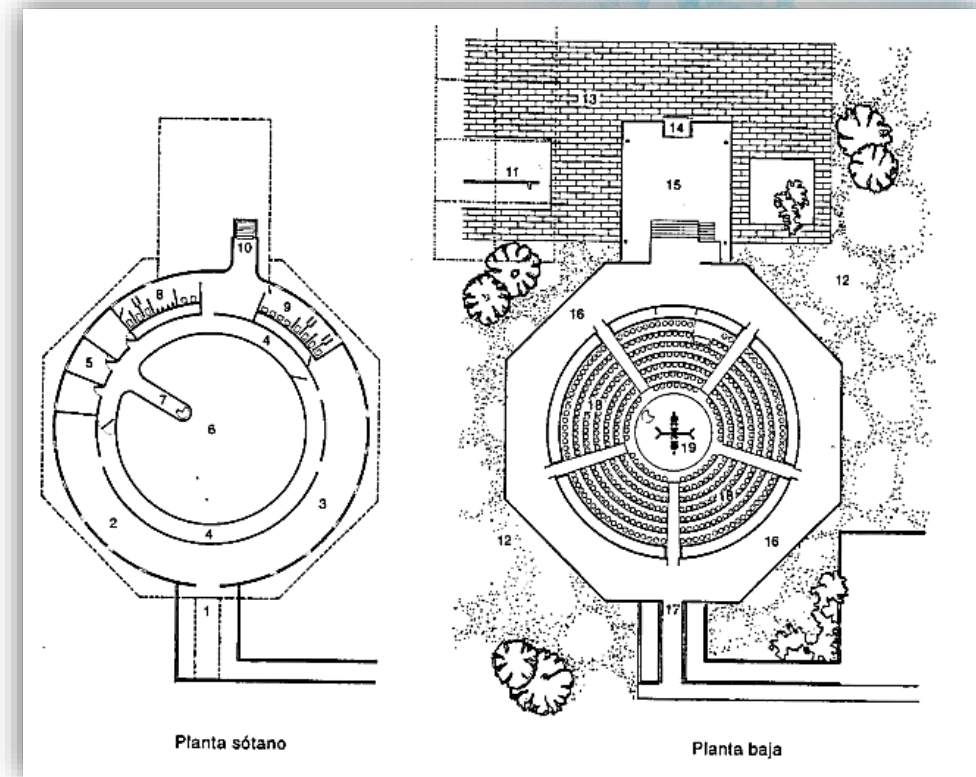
Planetario Luis Enrique Erro. Plantas arquitectónicas
